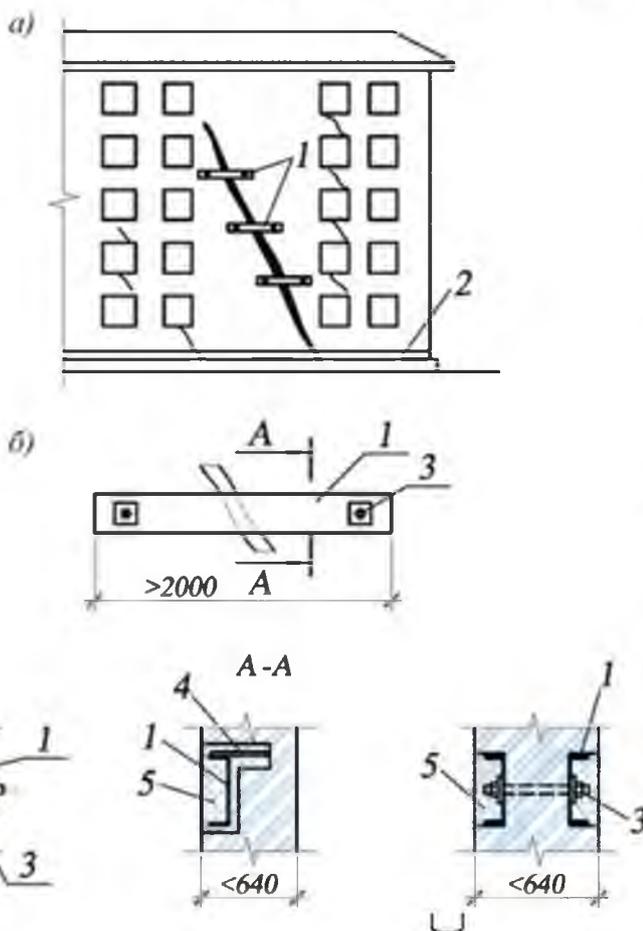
Посилення цегельних будівель за допомогою скоб-стяжок або розвантажувальних балок (розміри в см): *a* - фасад; *б* - фрагмент посилення, *1* - скоба-стяжка; *2* - розвантажувальна балка з швелера на рівні верху фундаменту (на рівні 1-го або підвального поверху), *3* - стягнутий болт, *4* - планка-анкер; *5* - бетон марки 100
